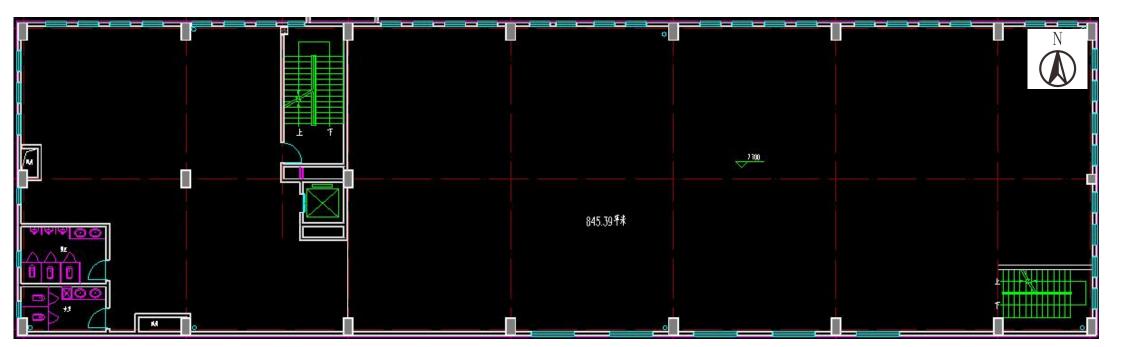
1#楼 3 层平面布置图(1: 100)
